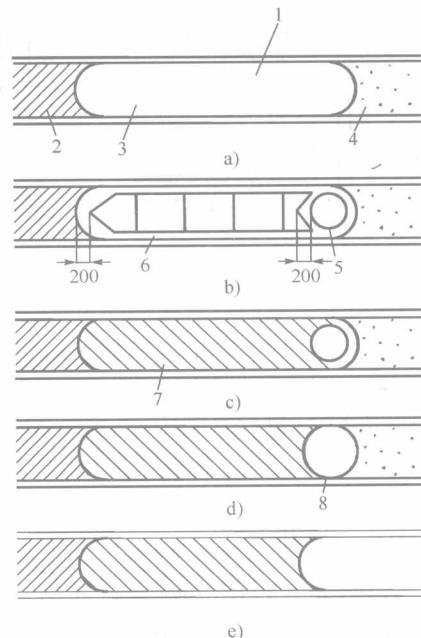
接头管接头的施工流程图(尺寸单位:mm)
